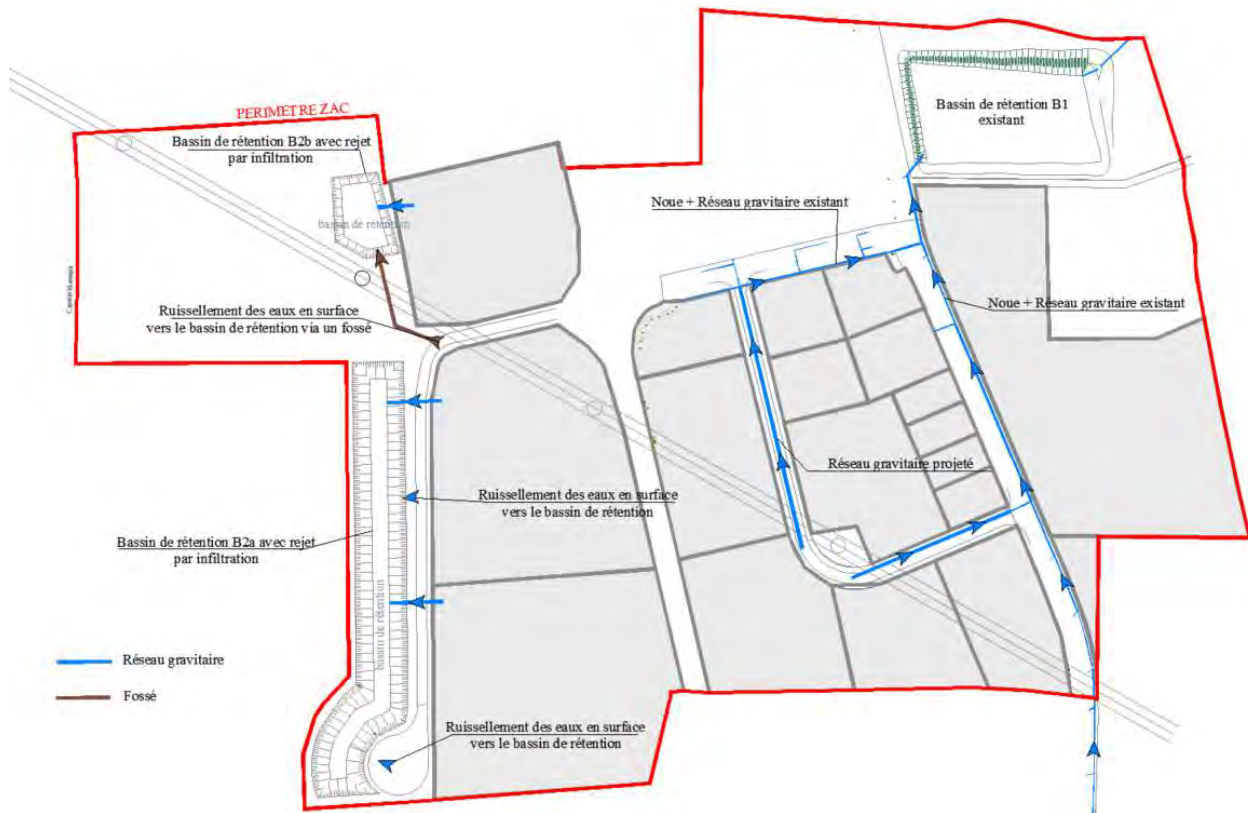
Plan des réseaux existants et projetés – eaux pluviales
